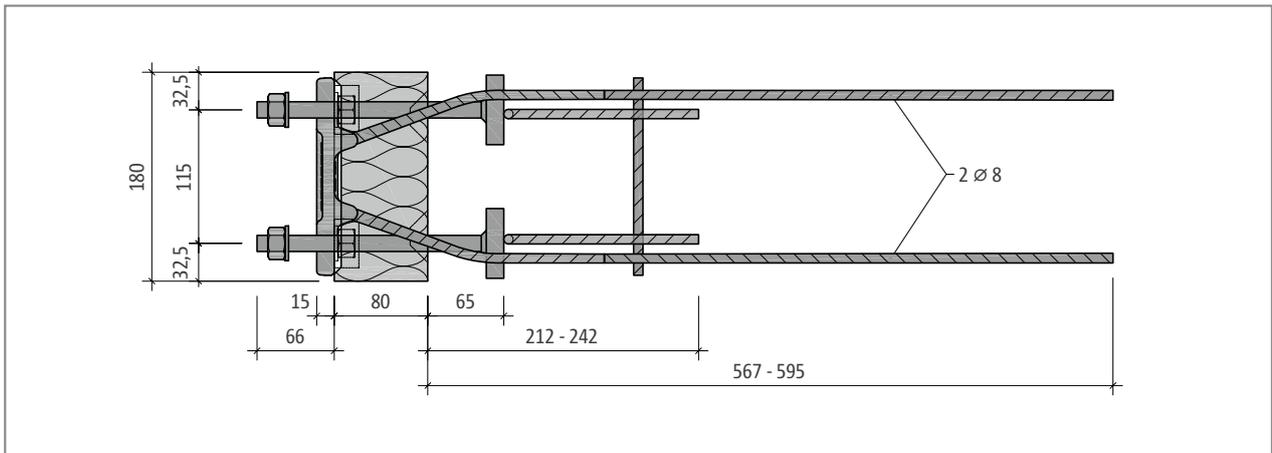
Schöck Isokorb® T type SQ-V1 : plan de base
